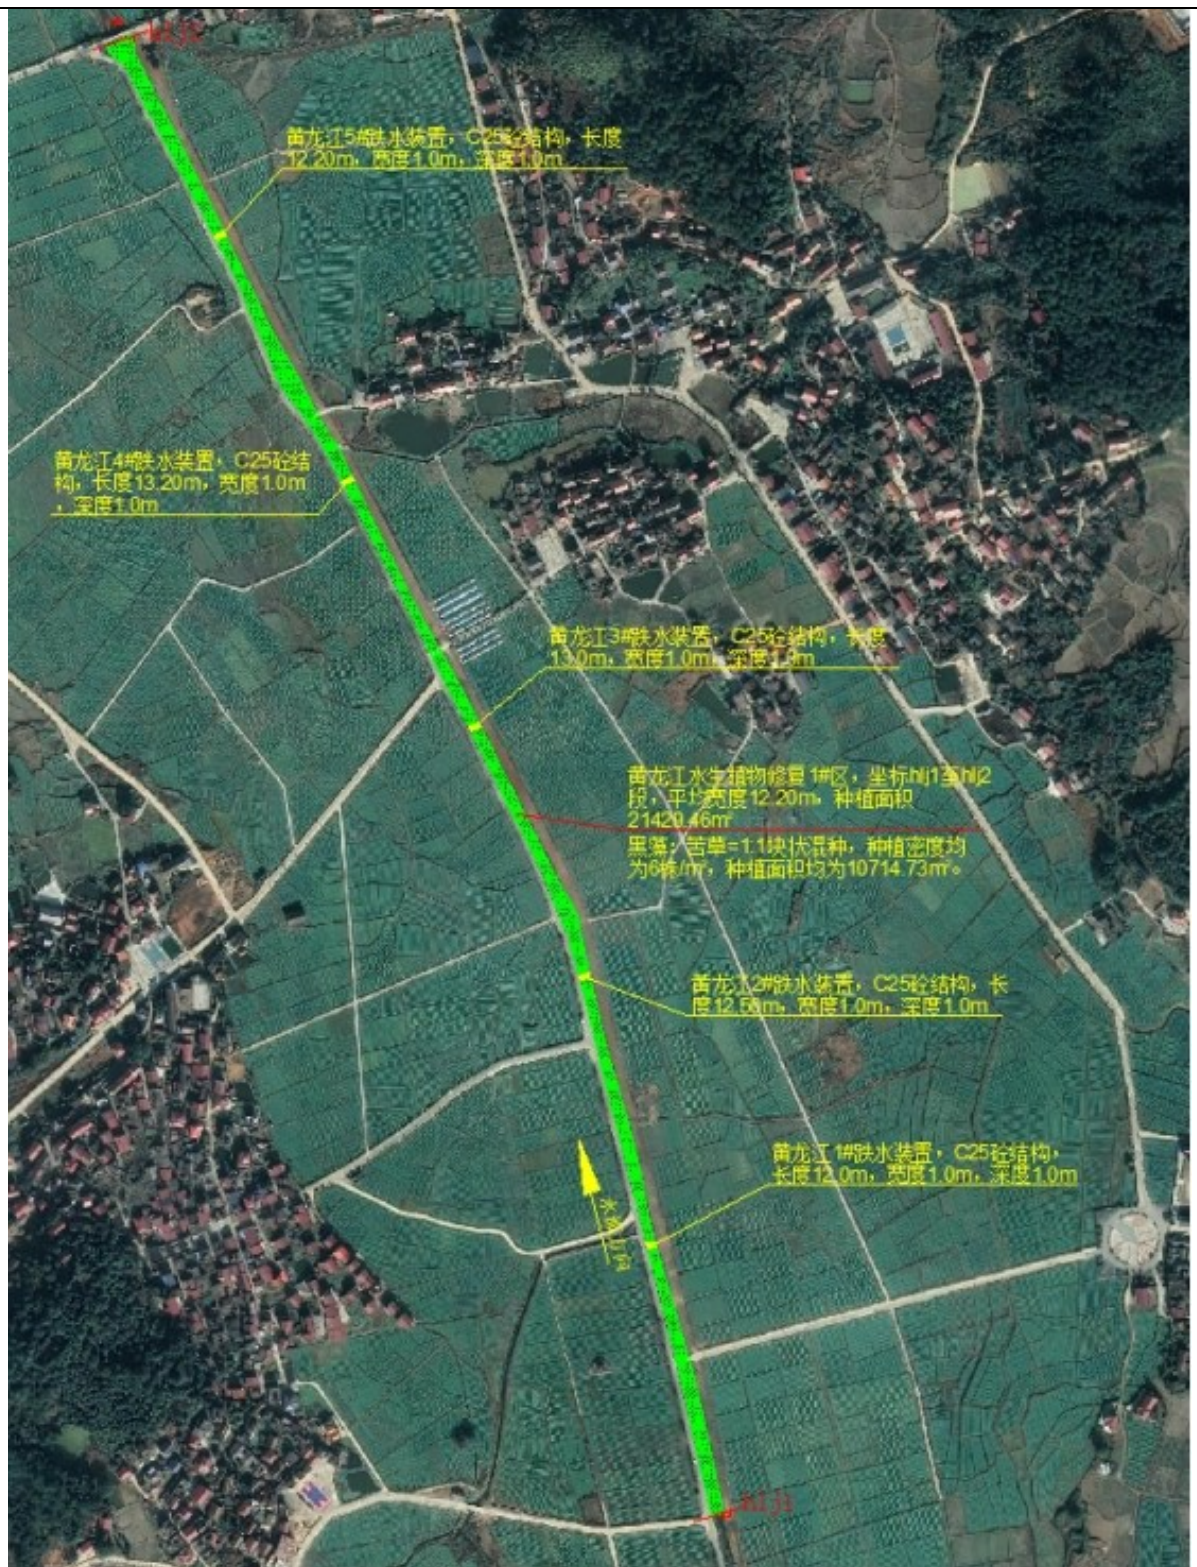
黄龙江水生植物修复设计图 设计总平面图
